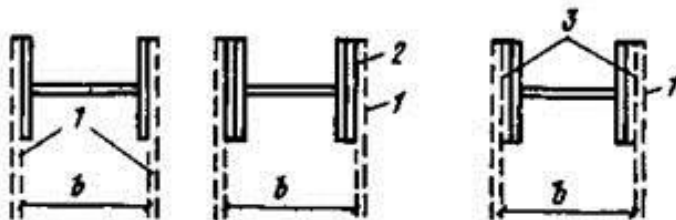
Размещение фасонки в тяжелых фермах
